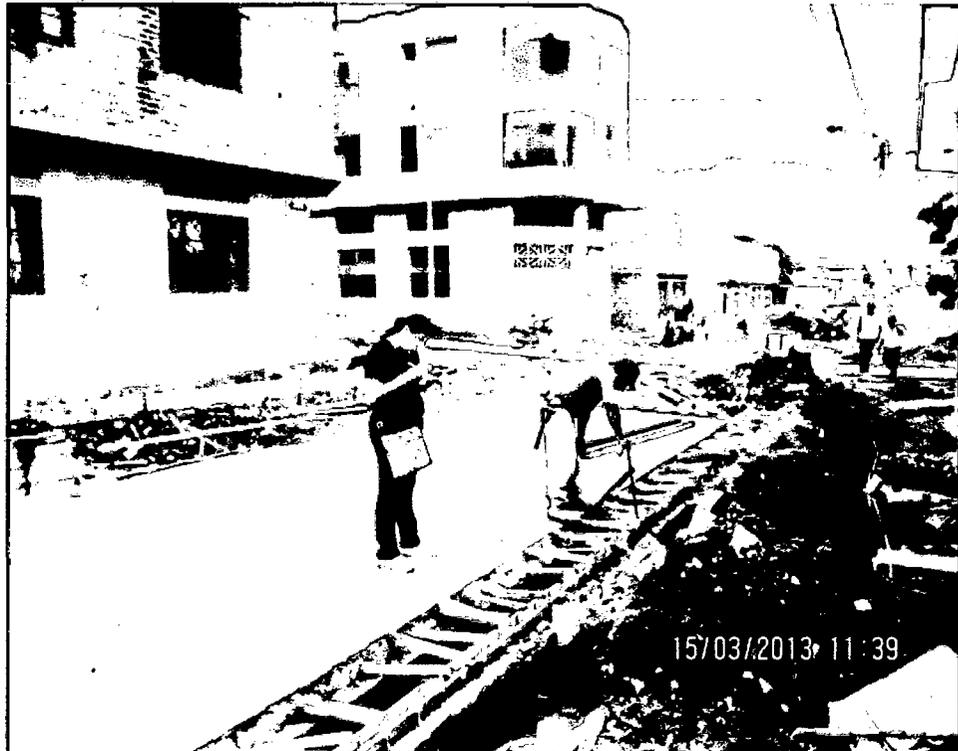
Desencofrado para losas de concreto en calle Prol. Manco Capac cdra. 6 – sector Morro Solar
